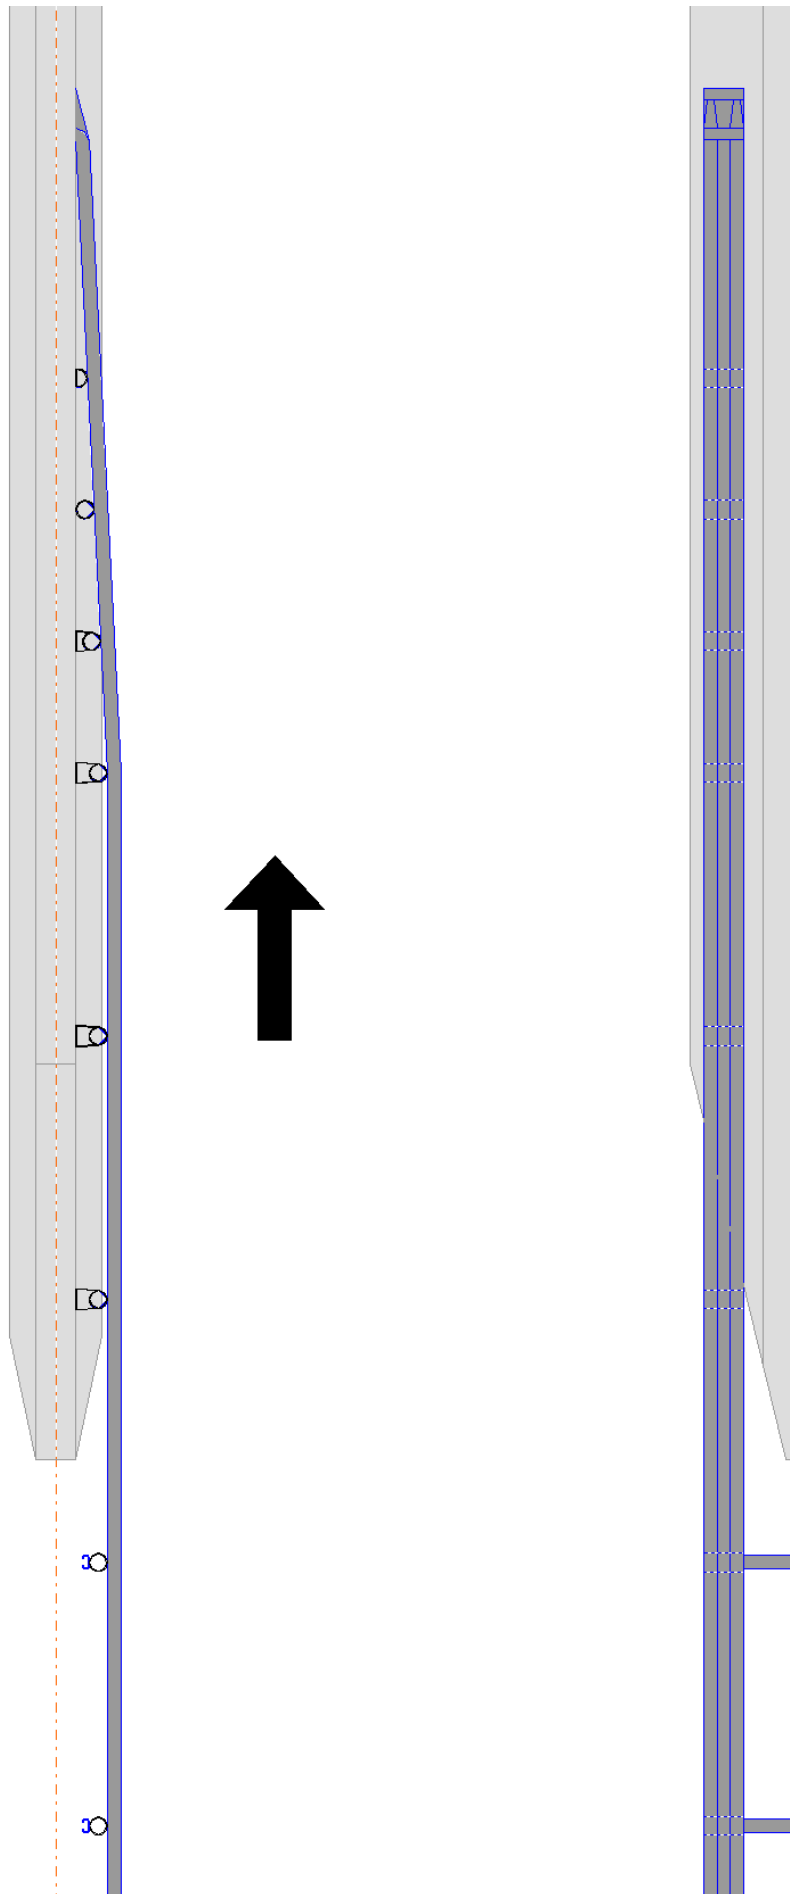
Principe de raccordement entre dispositif acier et dispositif béton.
